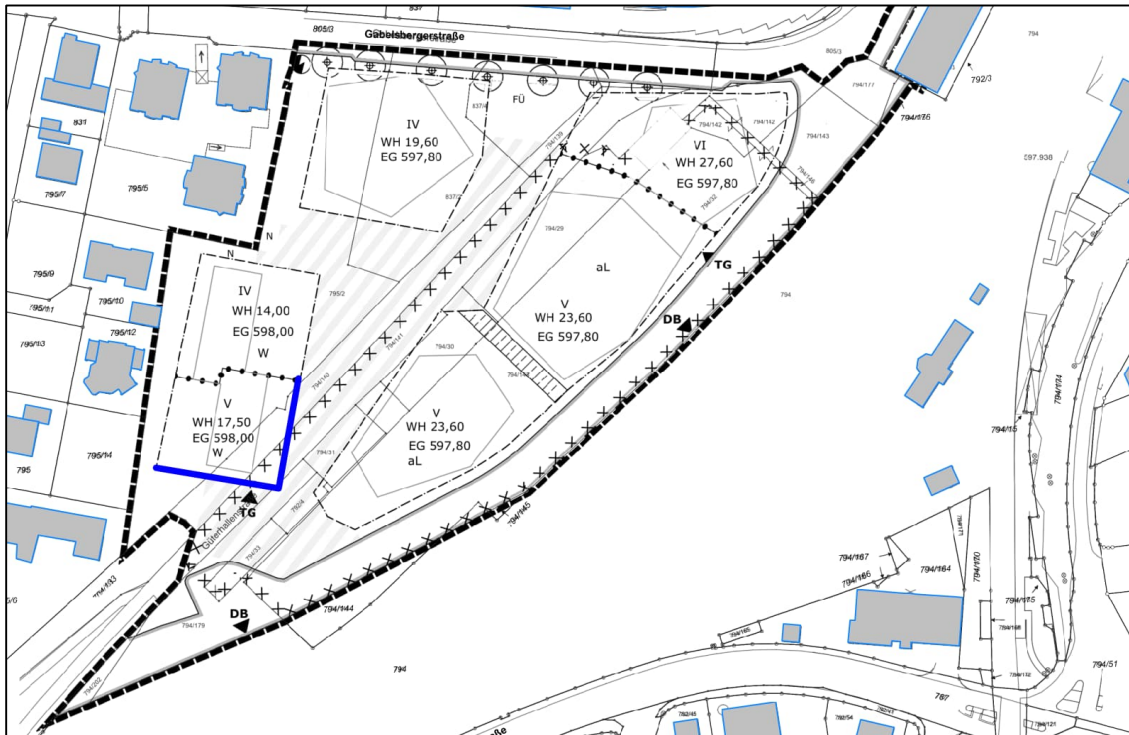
Lageplan mit Darstellung der Fassaden, entlang derer Außenwohnbereiche abgeschirmt werden müssen
